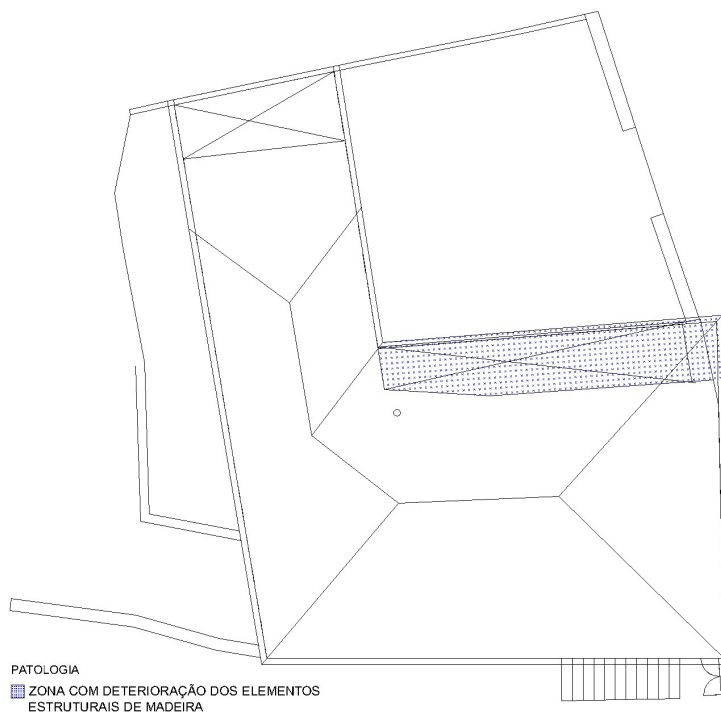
Representação da zona da cobertura com deterioração da estrutura em madeira - planta cobertura (sem escala).
